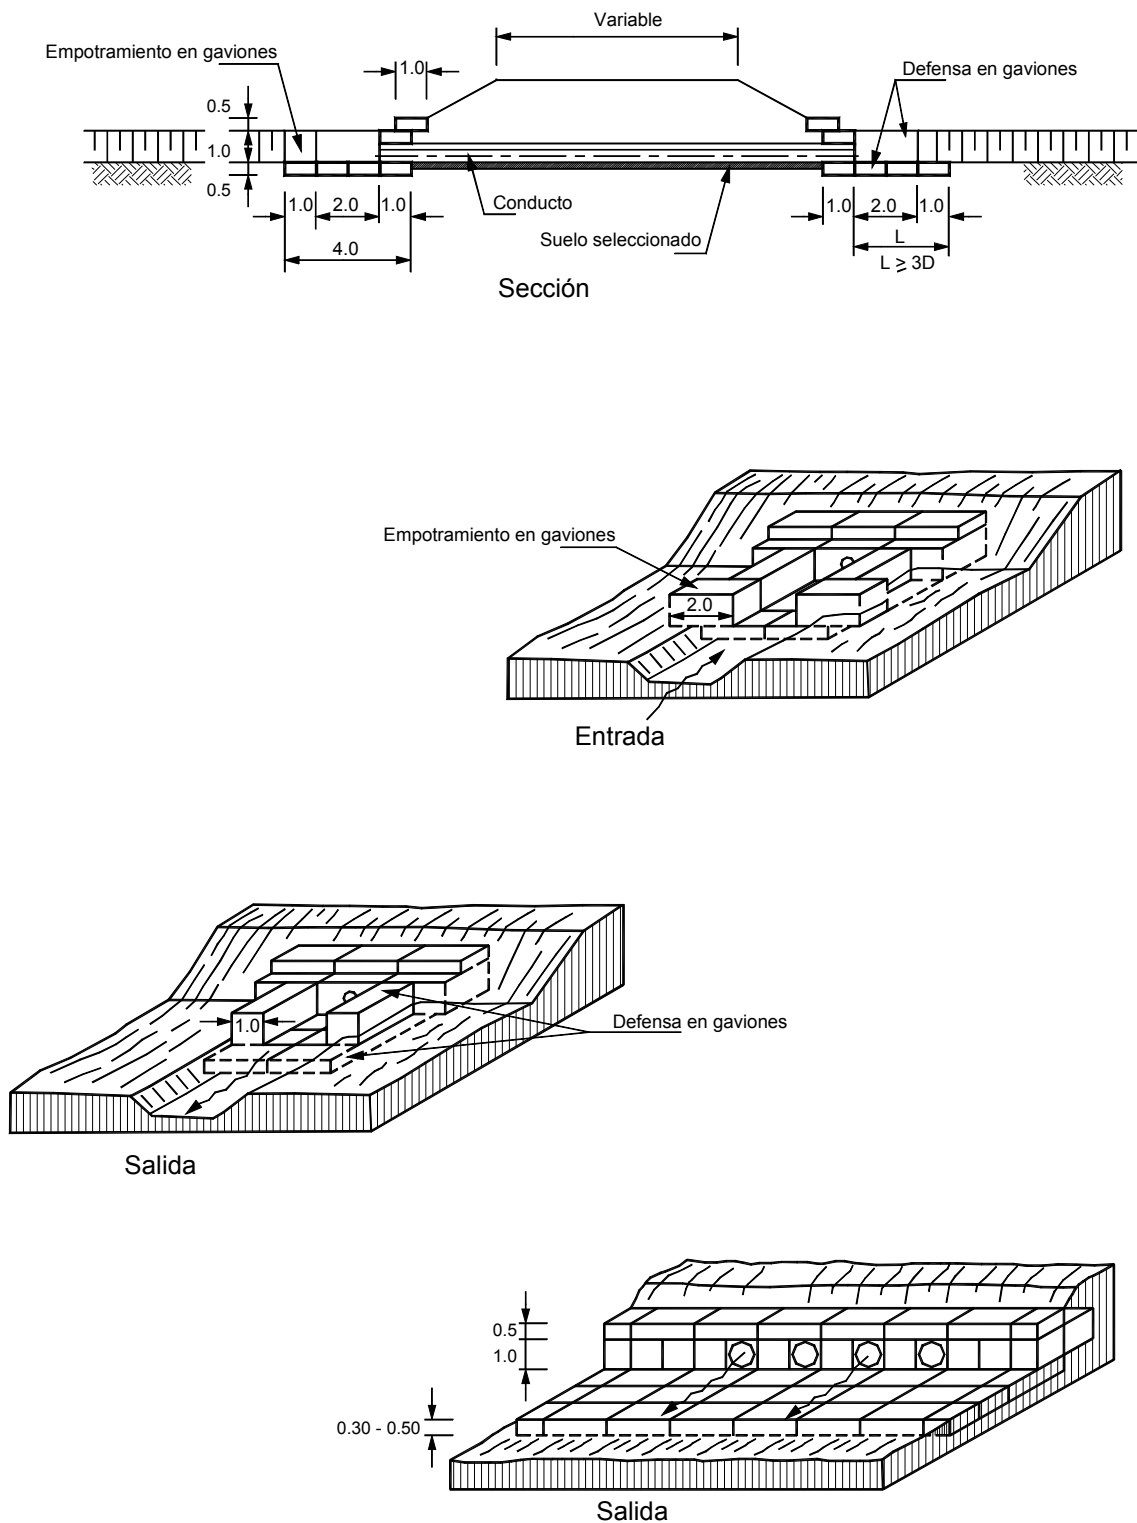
Protección en gaviones para alcantarillas en tubería.
